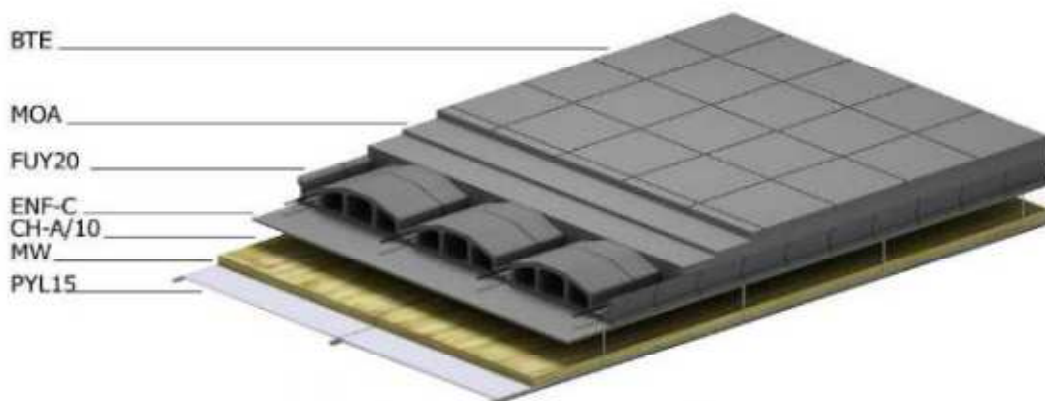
Detalle de aislamiento por debajo del soporte resistente. Panfleto comercial
